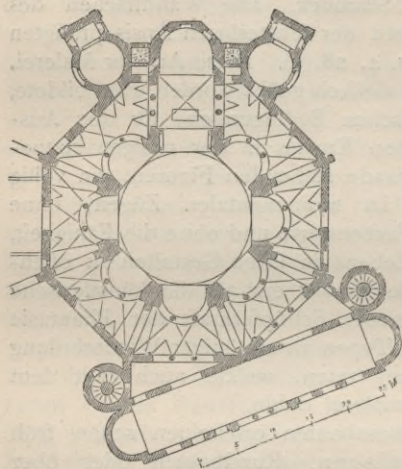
Grundriss von S. Vitale zu Ravenna.
